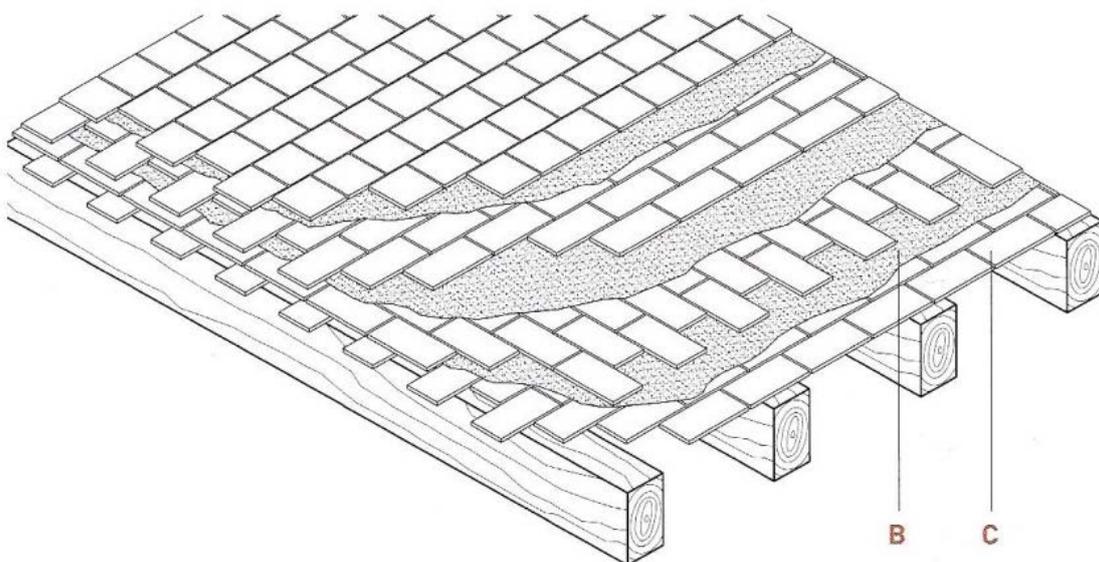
Detalle forjado entabicado (Vegas y Mileto, 2014. Pág. 142)
